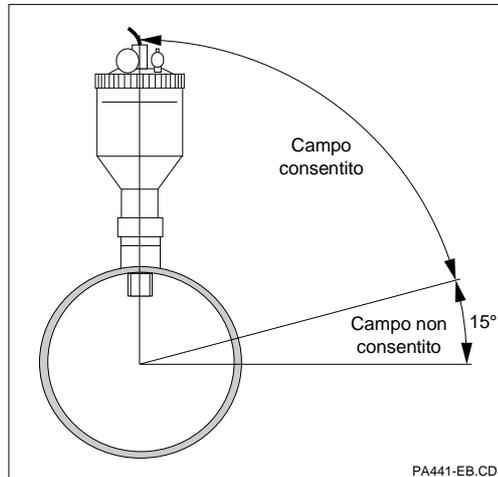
Posizione di montaggio permessa per CPA 441
